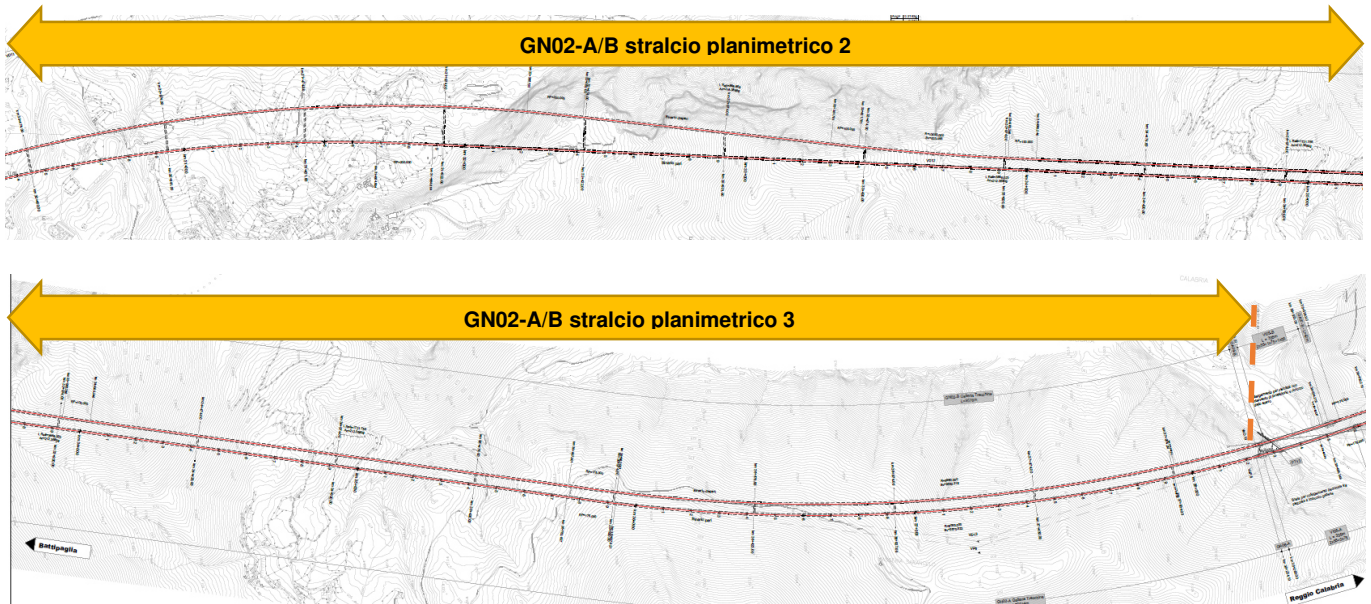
Planimetrie di progetto gallerie GN02-A/B da km 28+646 al km 38+260 BP
